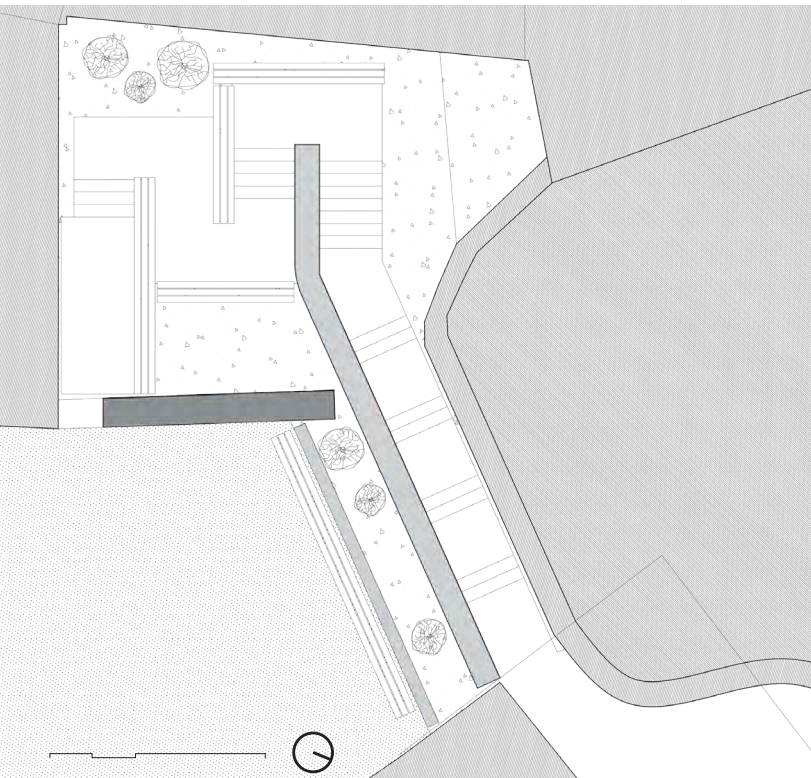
Planta de la intervención / Figure 2. Urban intervention plan.
